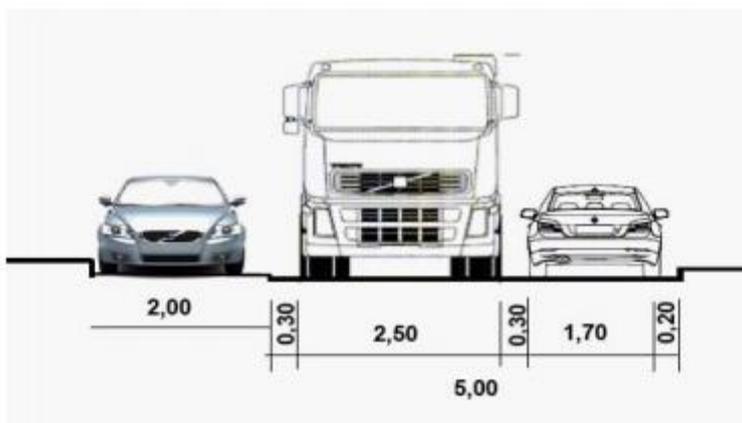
Profil de voie de desserte en double sens avec une place de parking longitudinale (source : idem fig.1)
